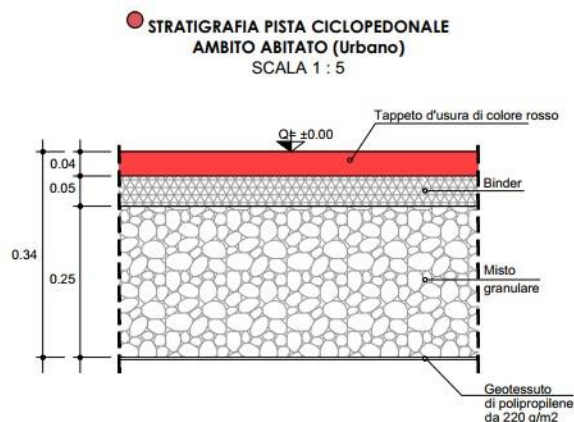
Pacchetto pavimentazione piste ciclopedonali
